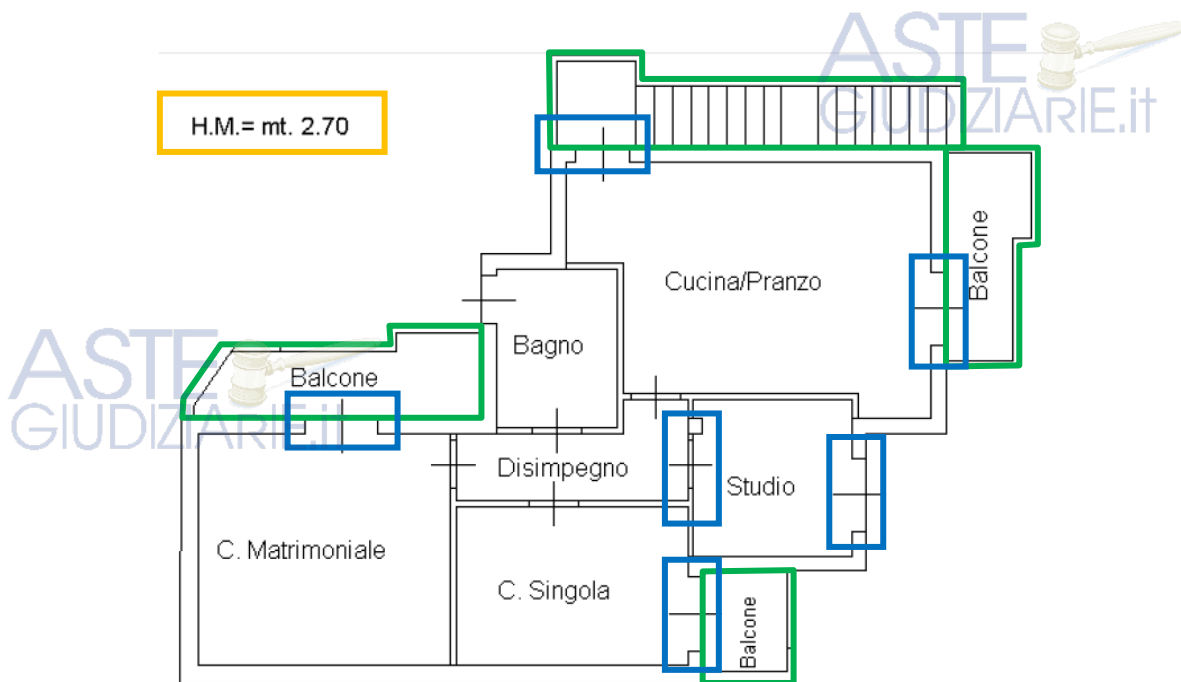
Planimetria catastale con indicazione della sagoma dell'immobile.
